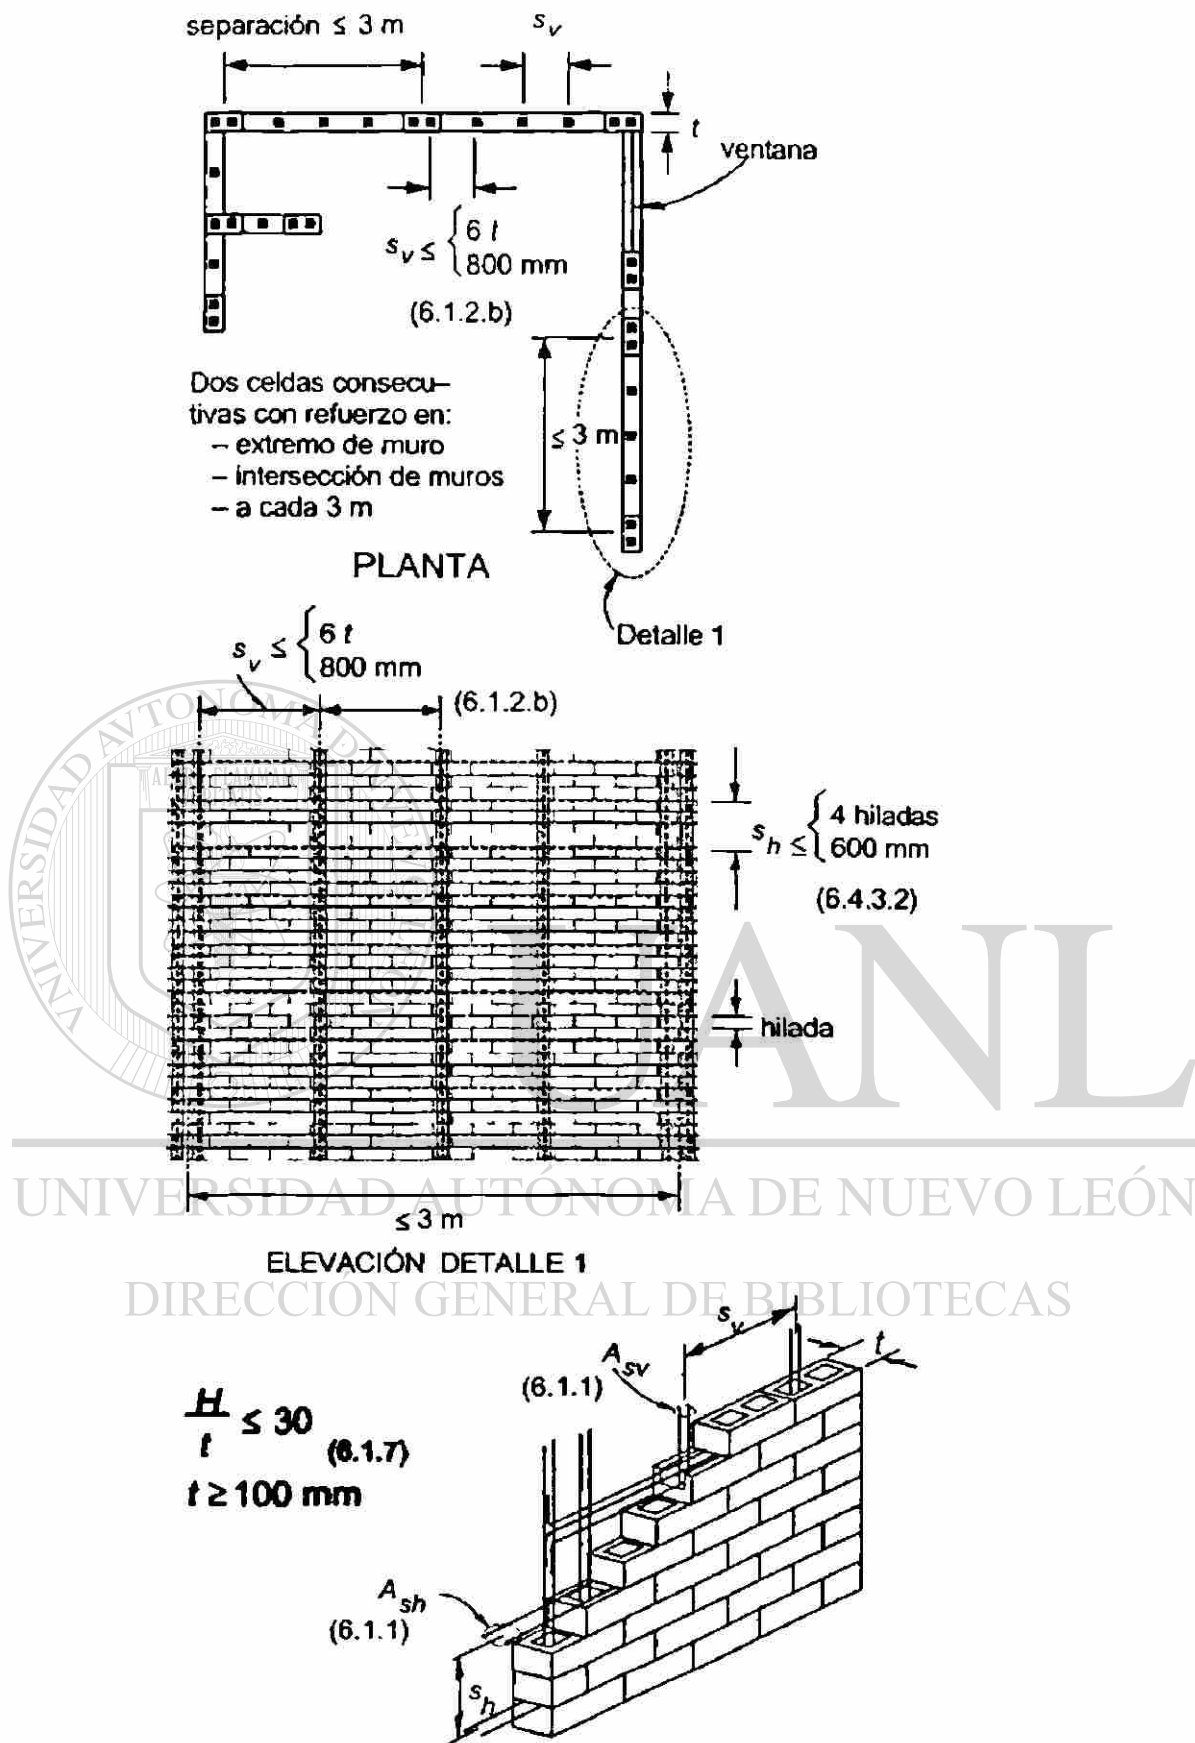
Requisitos para mampostería con refuerzo interior.
